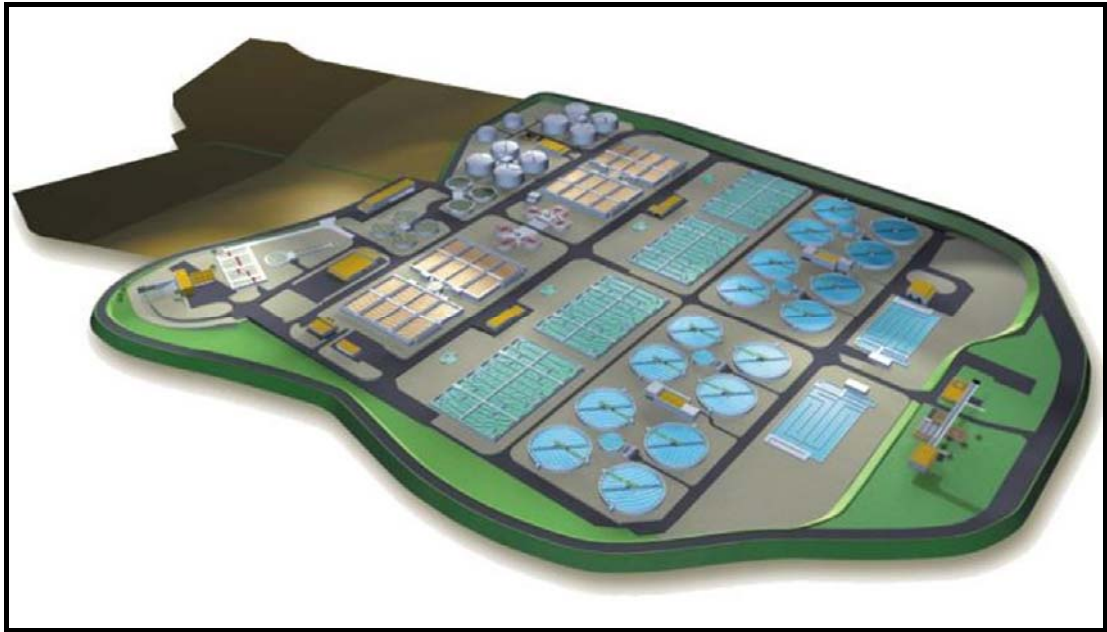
Esquema de vista general planta La Farfana (Aguas Andinas, 2000)
